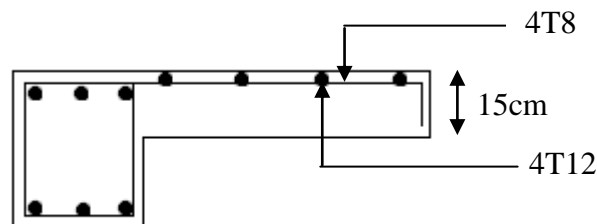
Schéma de ferrailage du porte à faux (terrasse) (Type 1,2)
